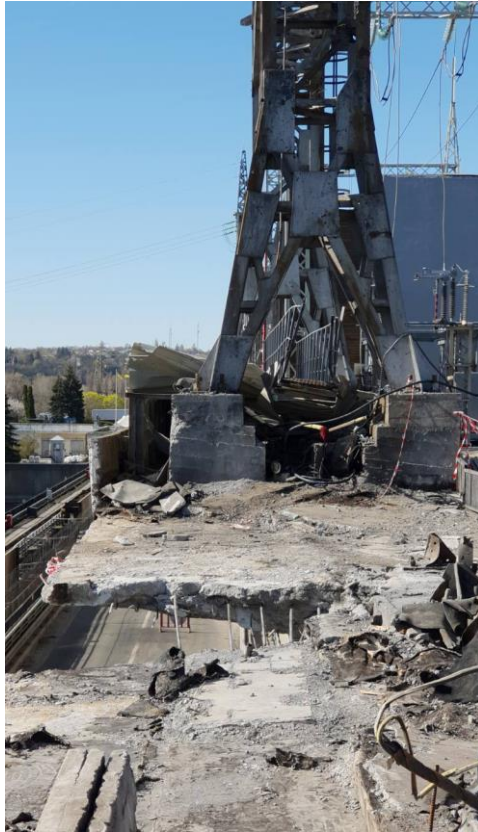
Руйнування консолі залізобетонної силової плити покриття внаслідок ракетного удару
